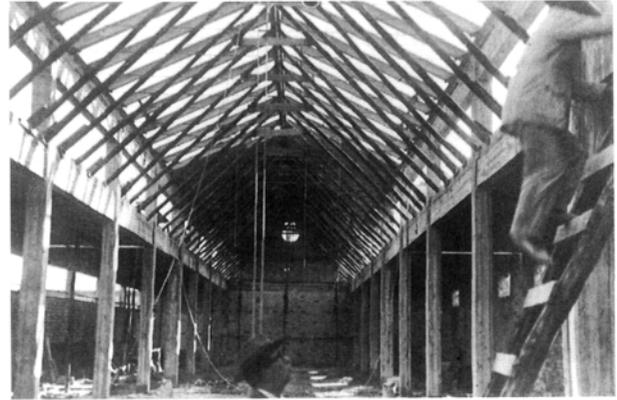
Forjado de cubierta apuntada, realizado con viguetas pretensadas en la década de 1950.
